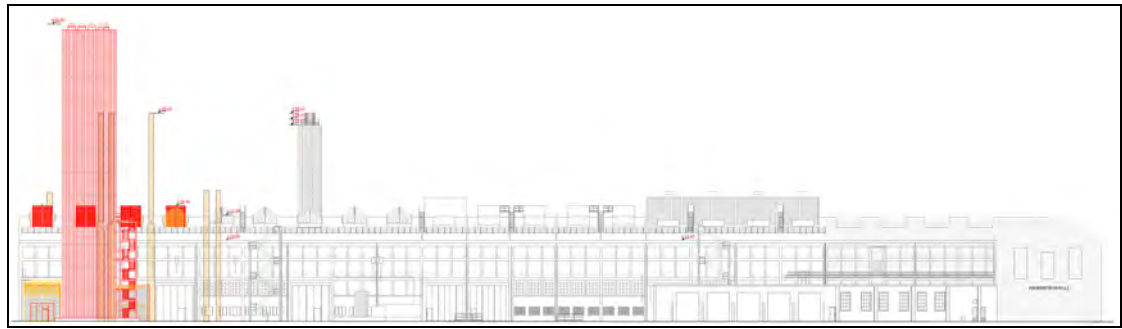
Estratto tav 03 – Progetto preliminare. Prospetto est (Confronto) (dall'interno della proprietà)
